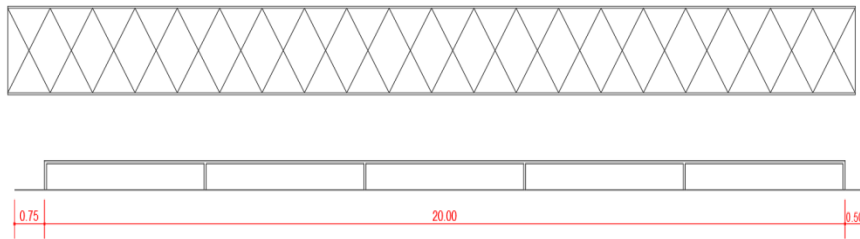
Vista en planta y lateral del obstáculo.
